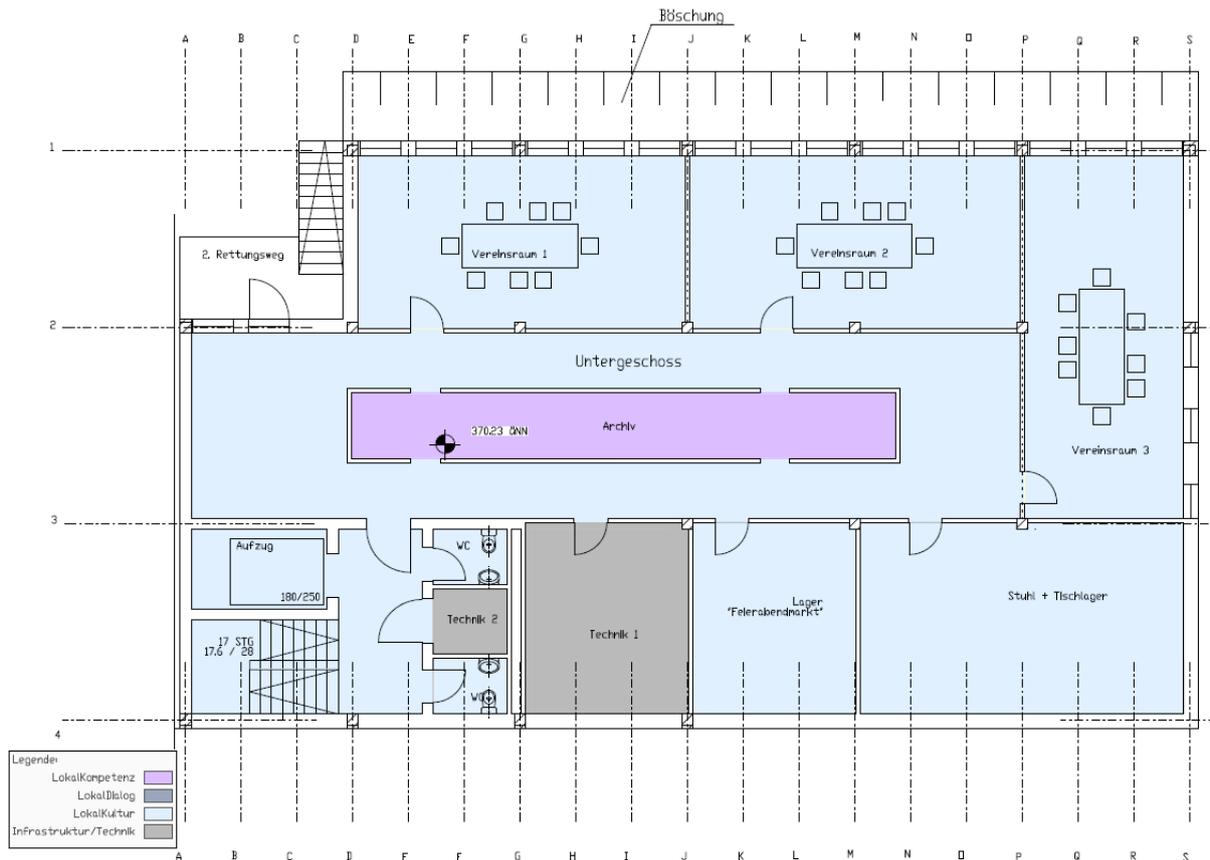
Untergeschoss WohnZimmer Nordstraße (vgl. Anlage), Quelle: Grundlage Planung Stadt Radevormwald
